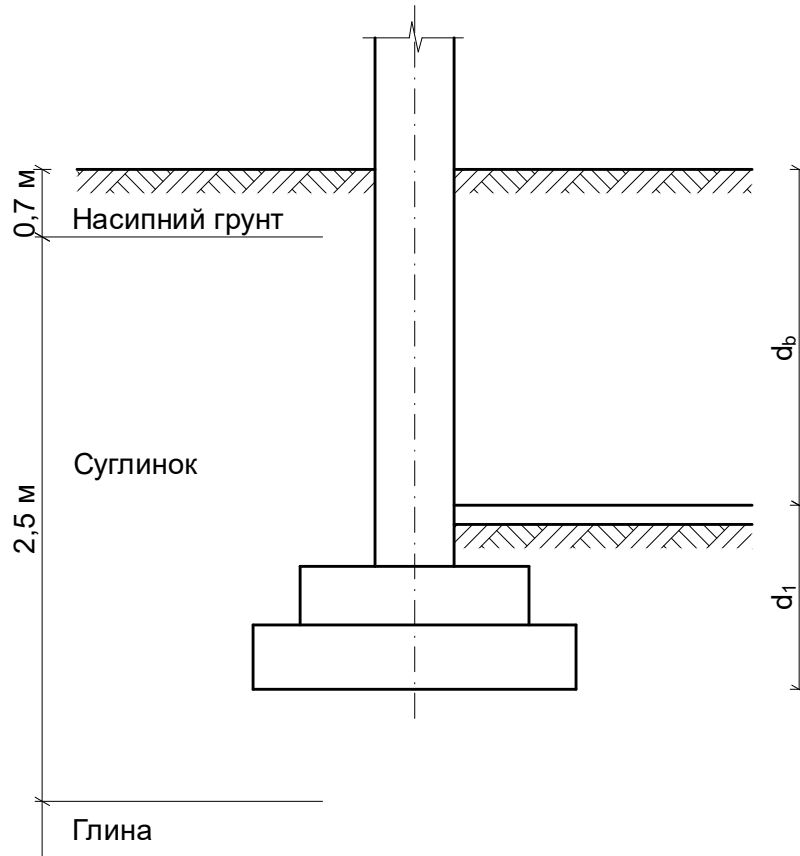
Схема розміщення фундаменту у ґрунті
